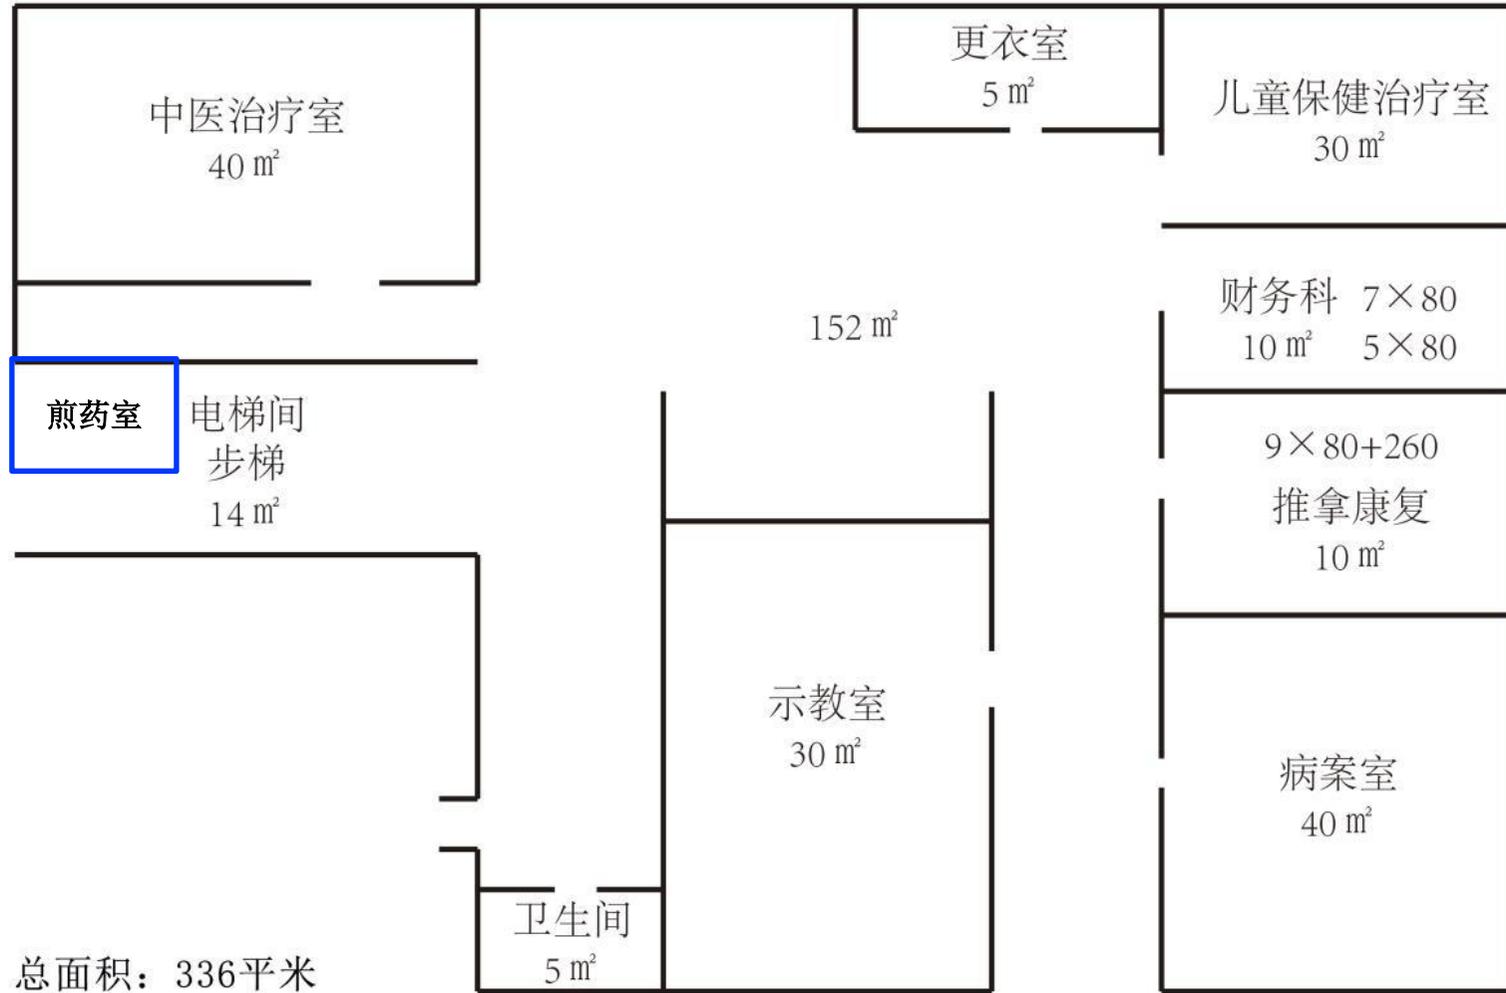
(3) 现有项目平面布置图 (六楼东侧)
